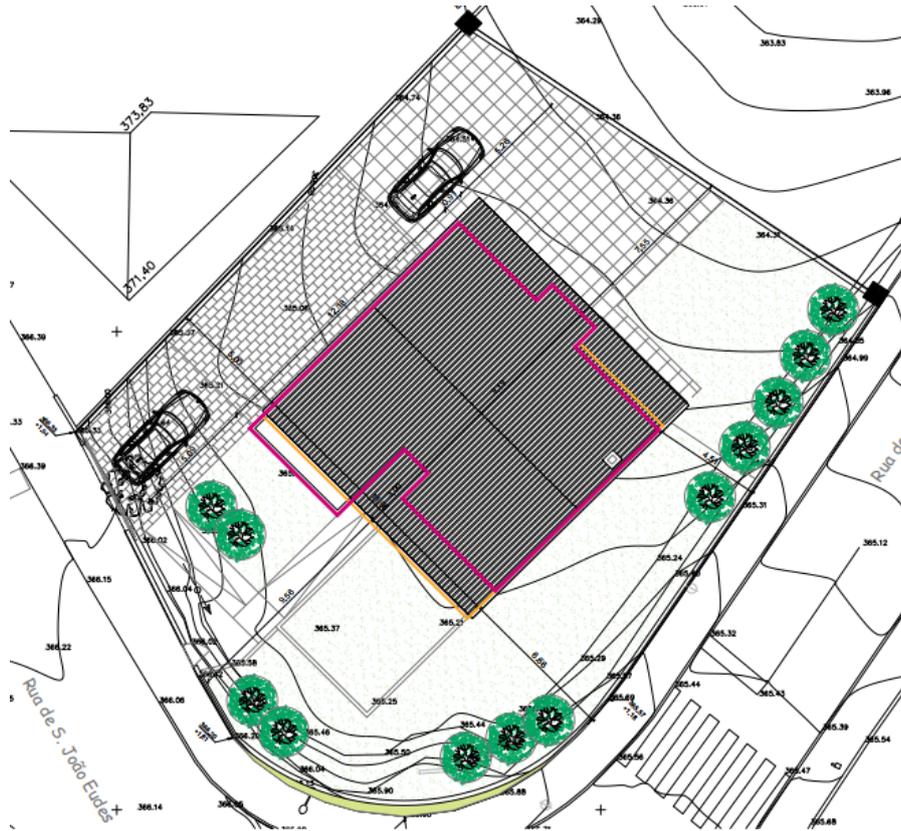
Planta de implantação sobre levantamento topográfico. Autoria de Pedro Mortal. 2023
